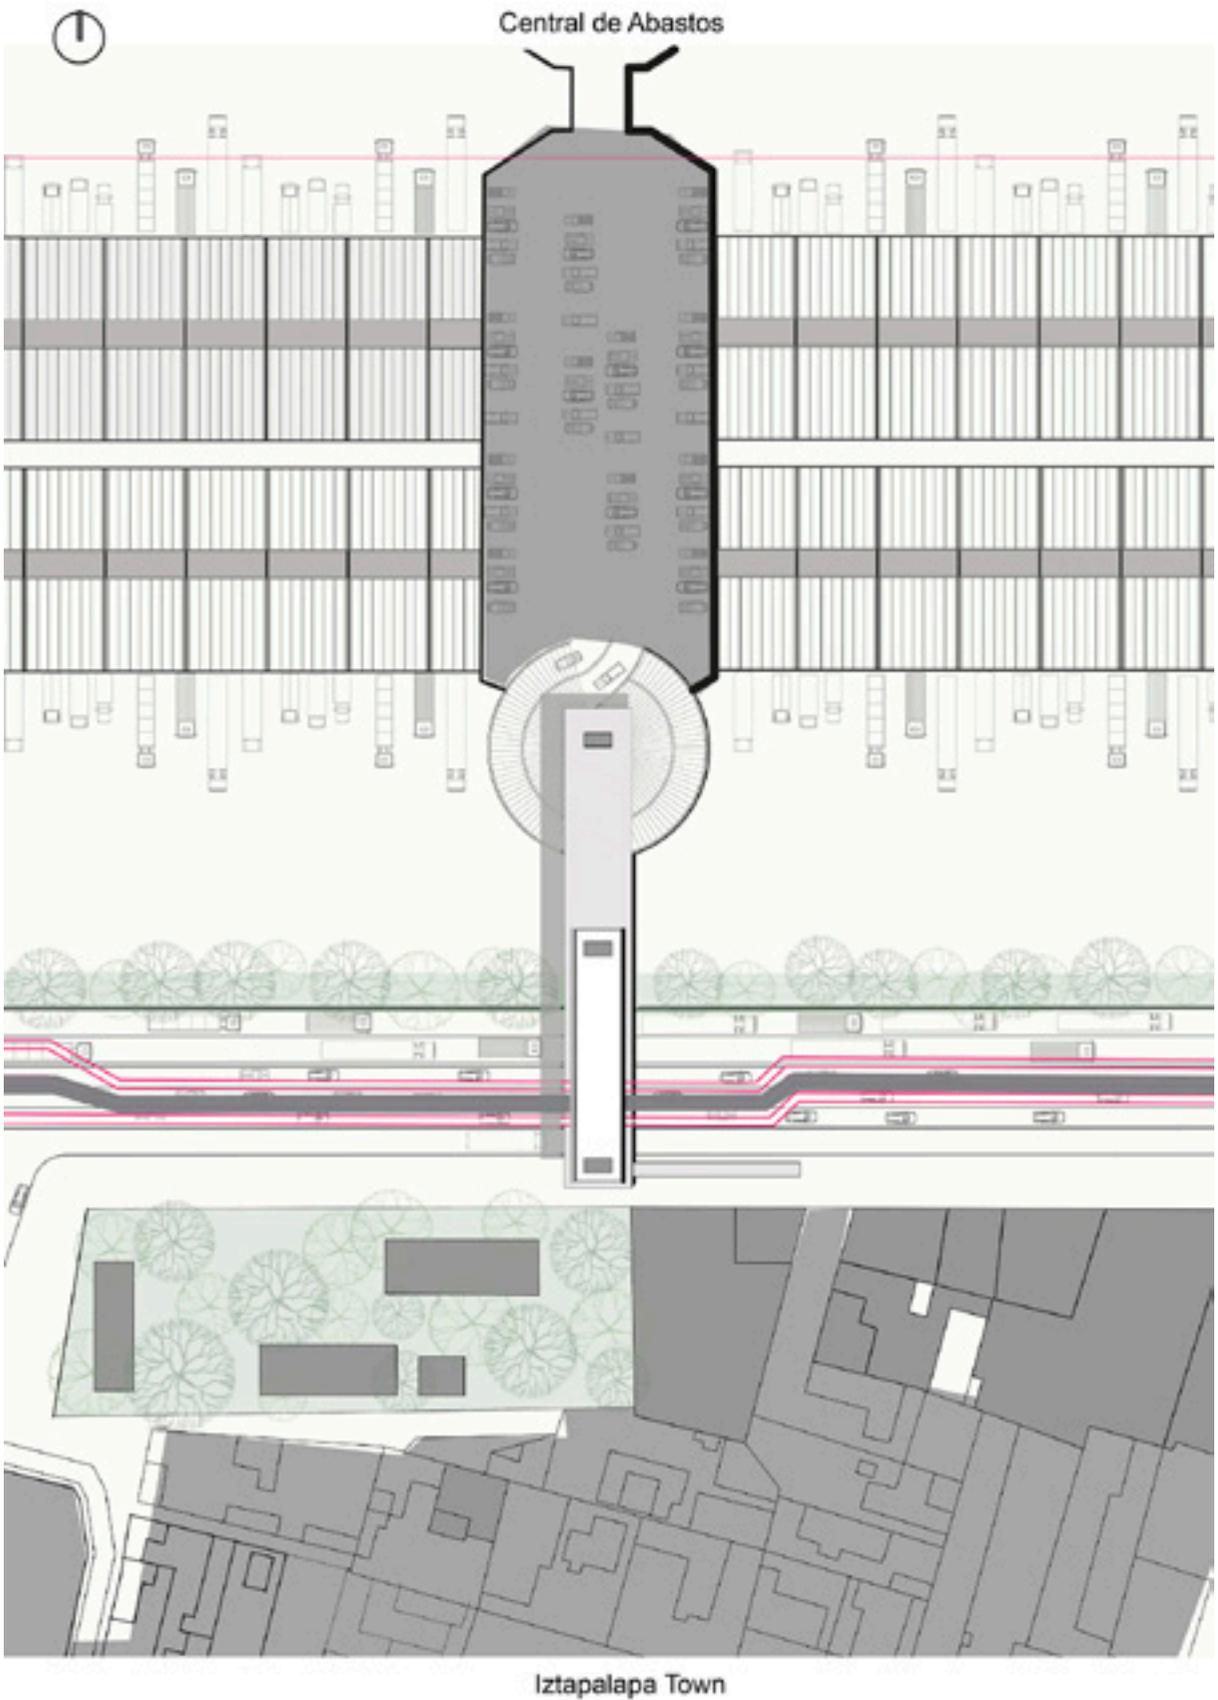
Detalle en planta de puente programático del proyecto. Elaboración THU.
